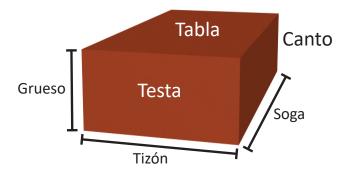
Dimensiones del ladrillo Fuentes: Elaboración propia
